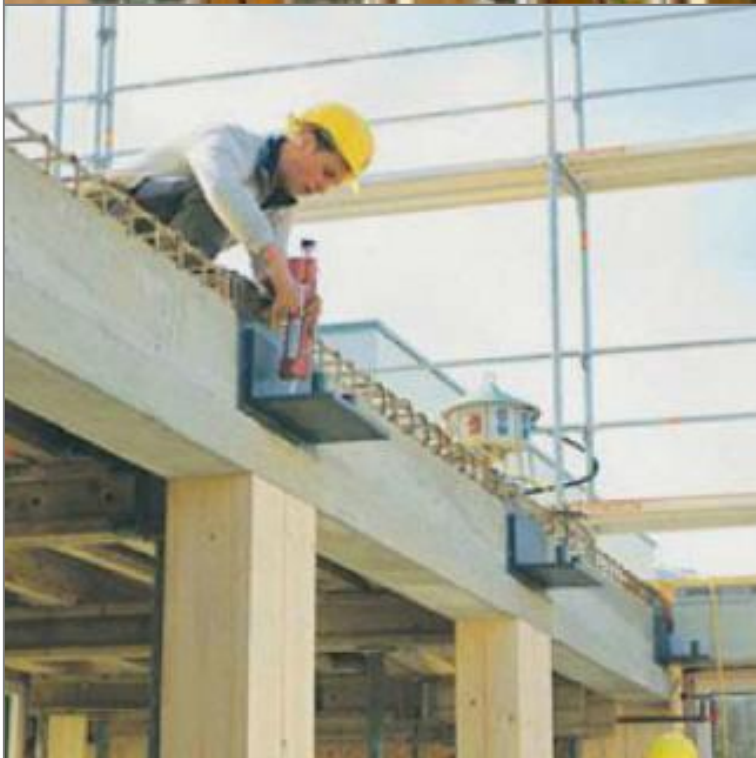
Ângulos metálicos de fixação entre o reforço de betão da viga e os elementos de piso
